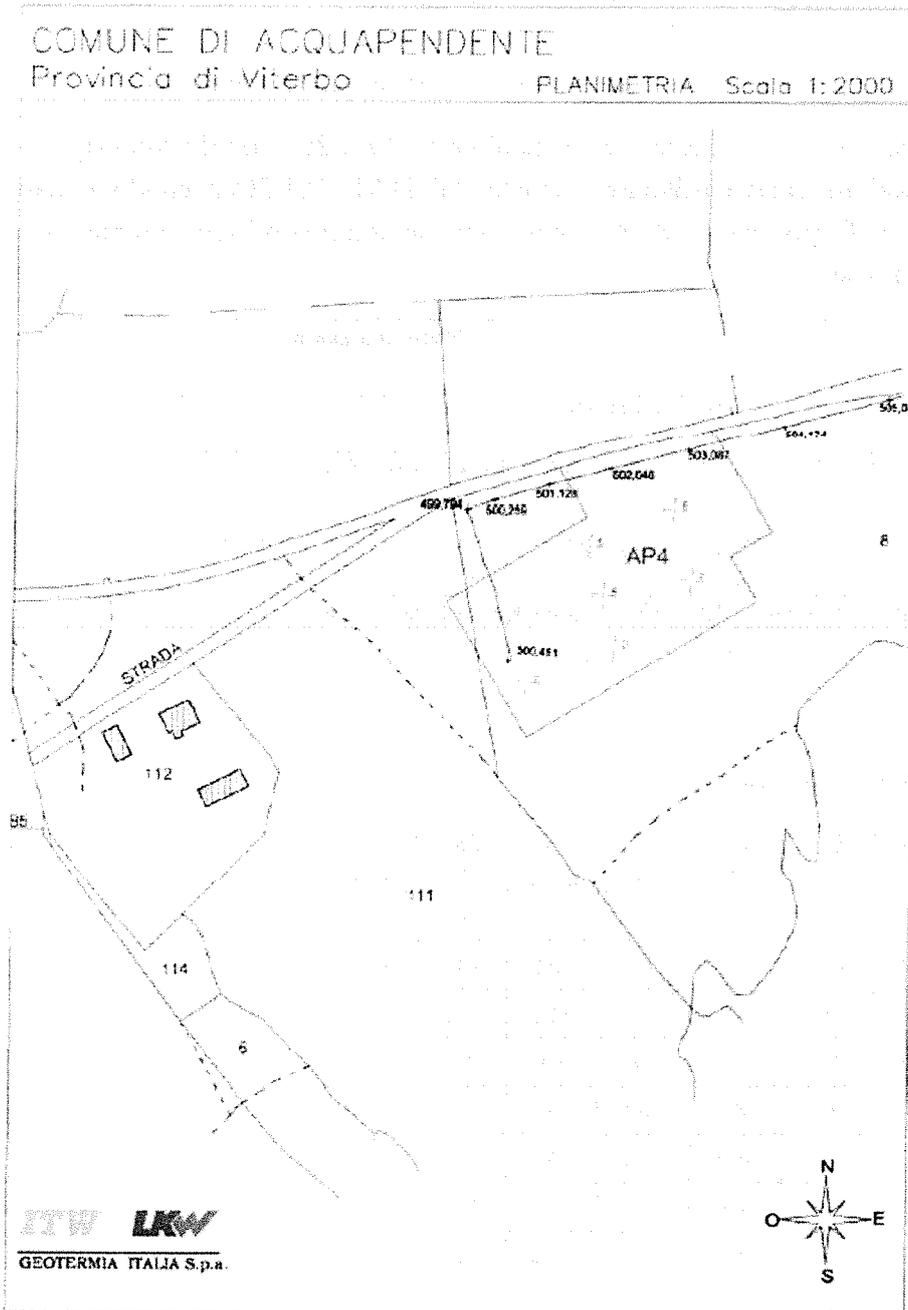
Planimetria della postazione AP4 con l'indicazione dei punti di sondaggio
